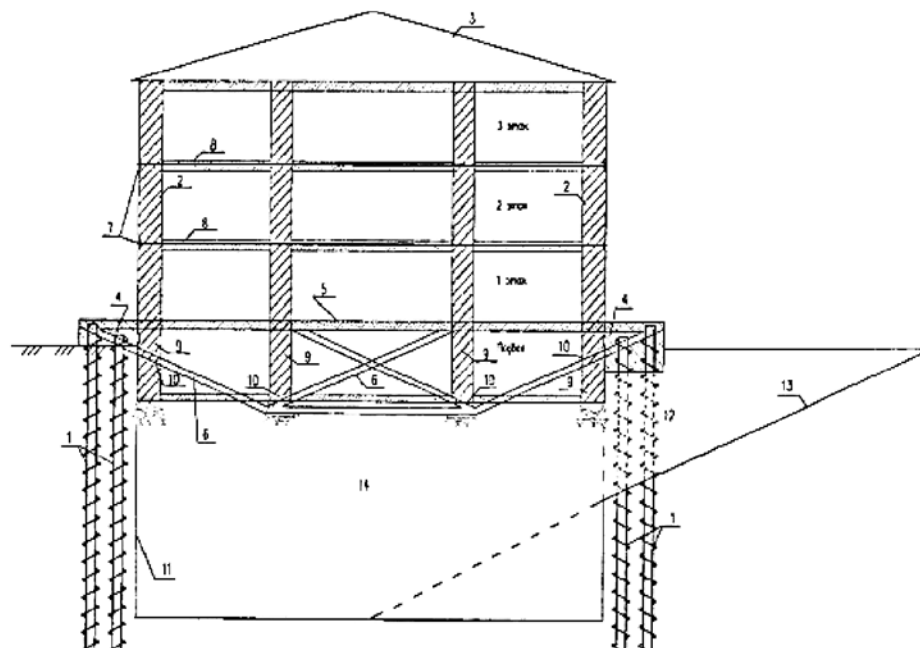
Схема влаштування підземного поверху: 1 - одинарний або подвійний ряд паль; 2, 3 - будівля; 4 - складний ростверк; 5 - ж/б плита; 6 - стержні ферм; 7 - пояси підсилення; 8 - перекриття; 9 - стіна підвалу або цокольного поверху; 10 - отвори для стержнів ферм; 11 - обсяг підземного об'єкта; 12 - порталний отвір; 13 - пандус; 14 - ґрунт
